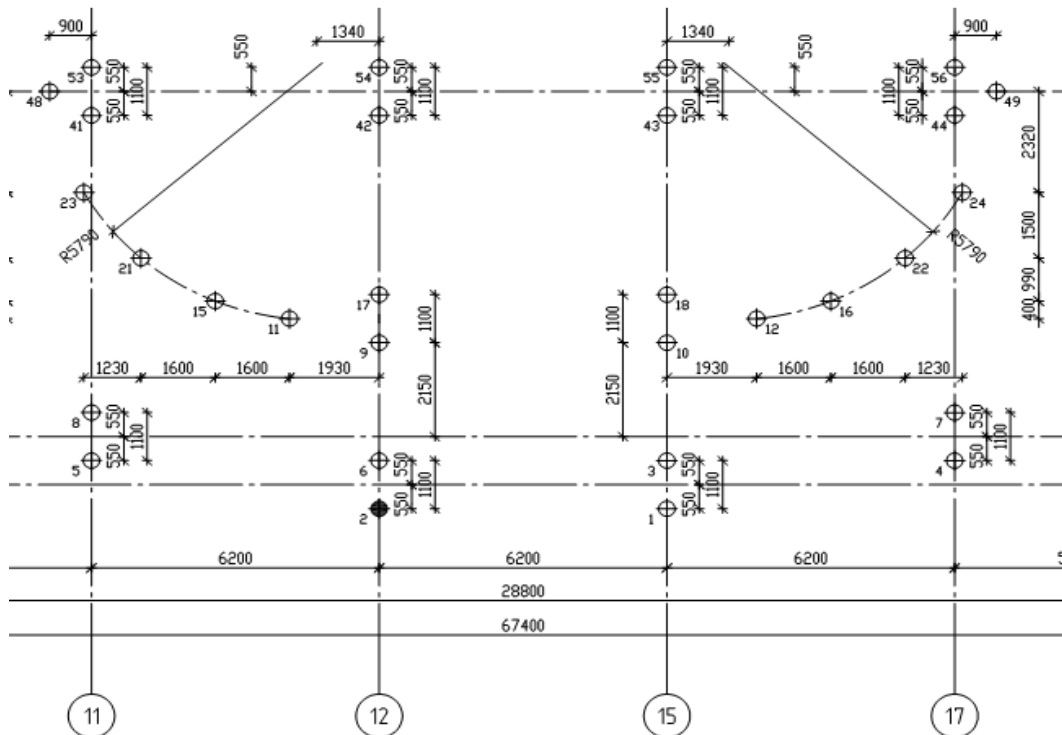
Фрагмент плану пального поля будівлі із 588 палів
